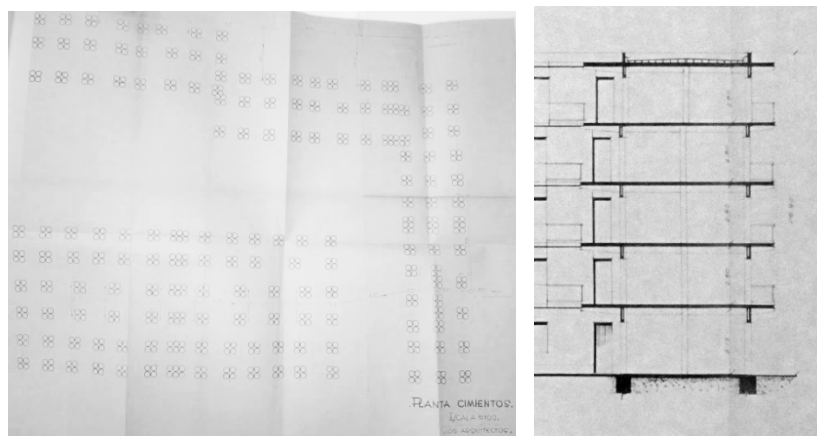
Planos originales del proyecto de ejecución de la cimentación y sección longitudinal bloque Y. *Fuente AMAG.
